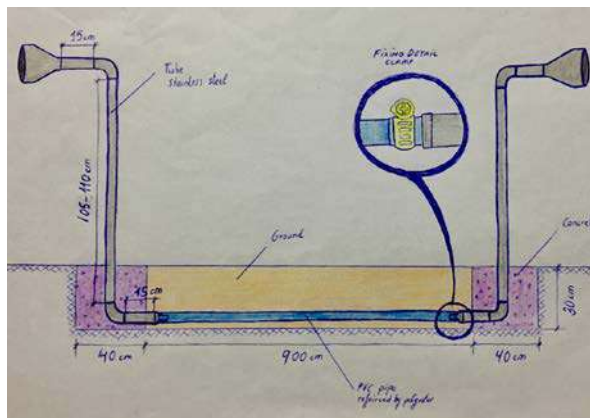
Detalle plano del elemento Speaking phones. Fuente: propia.
